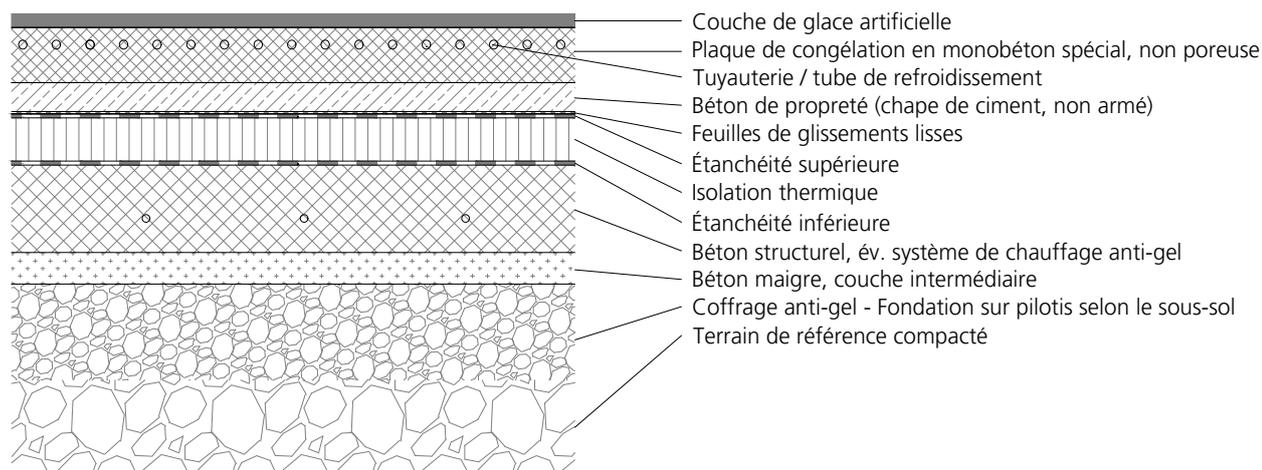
Exemple de construction d'une dalle de froid avec une dalle porteuse sur terrain (étanche)
